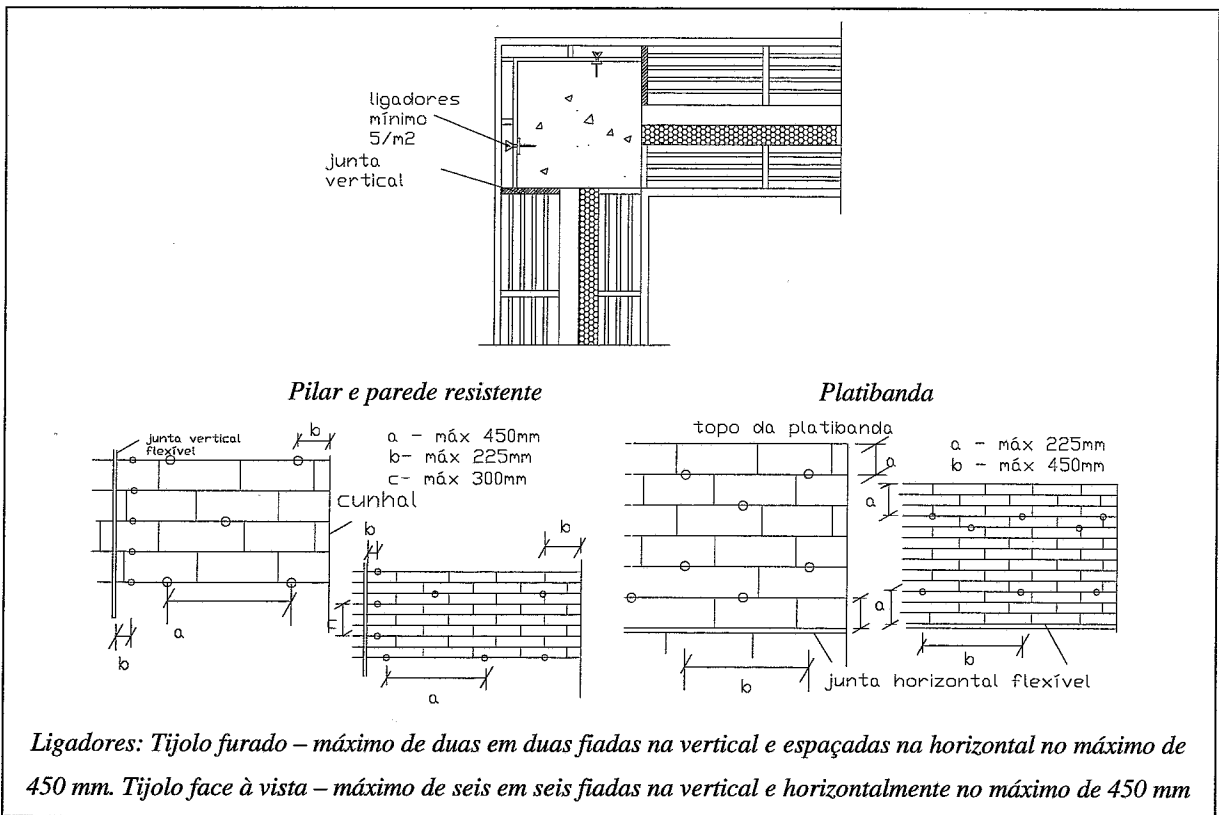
Pormenor da fixação da forra cerâmica exterior em zona de pilar, parede ou platibanda com a colocação de grampos nas juntas horizontais
